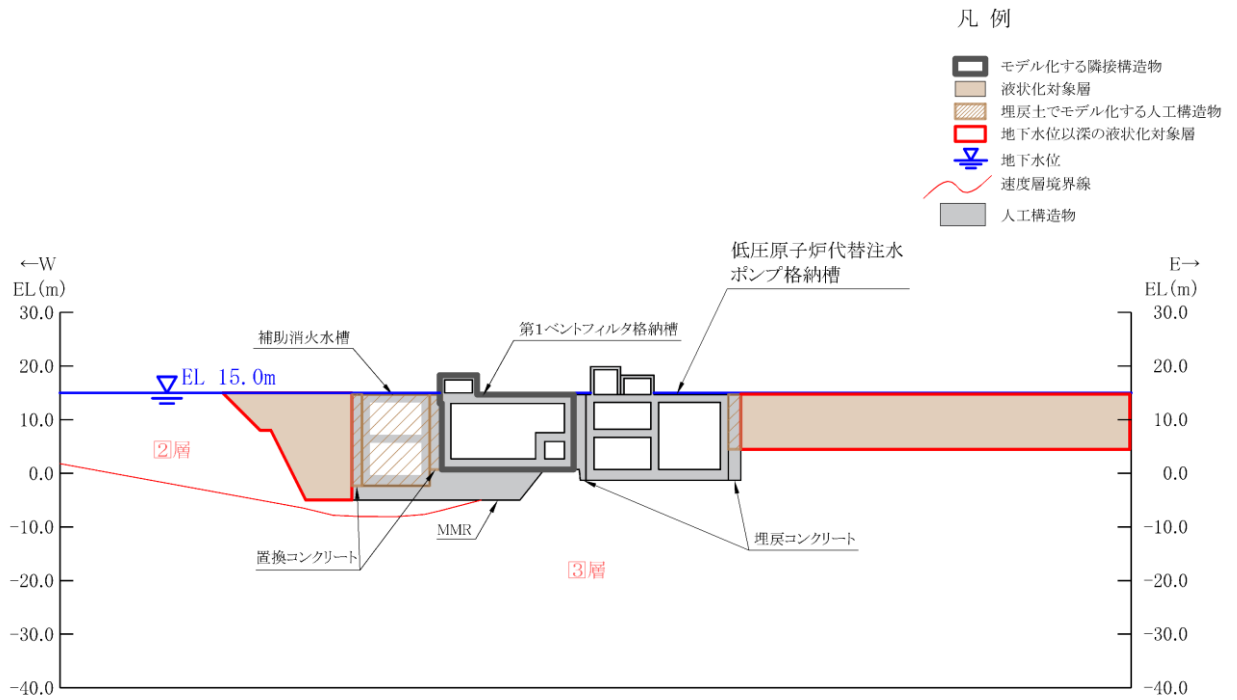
低圧原子炉代替注水ポンプ格納槽 評価対象断面図 (B-B 断面位置)
